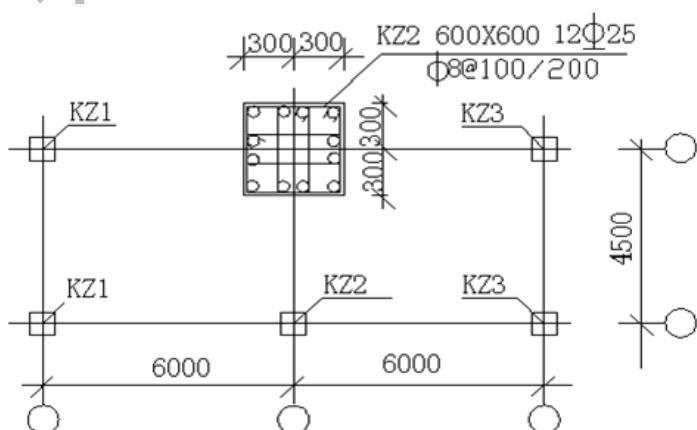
柱配筋图 (-0.85—7.77 柱平法施工图)
